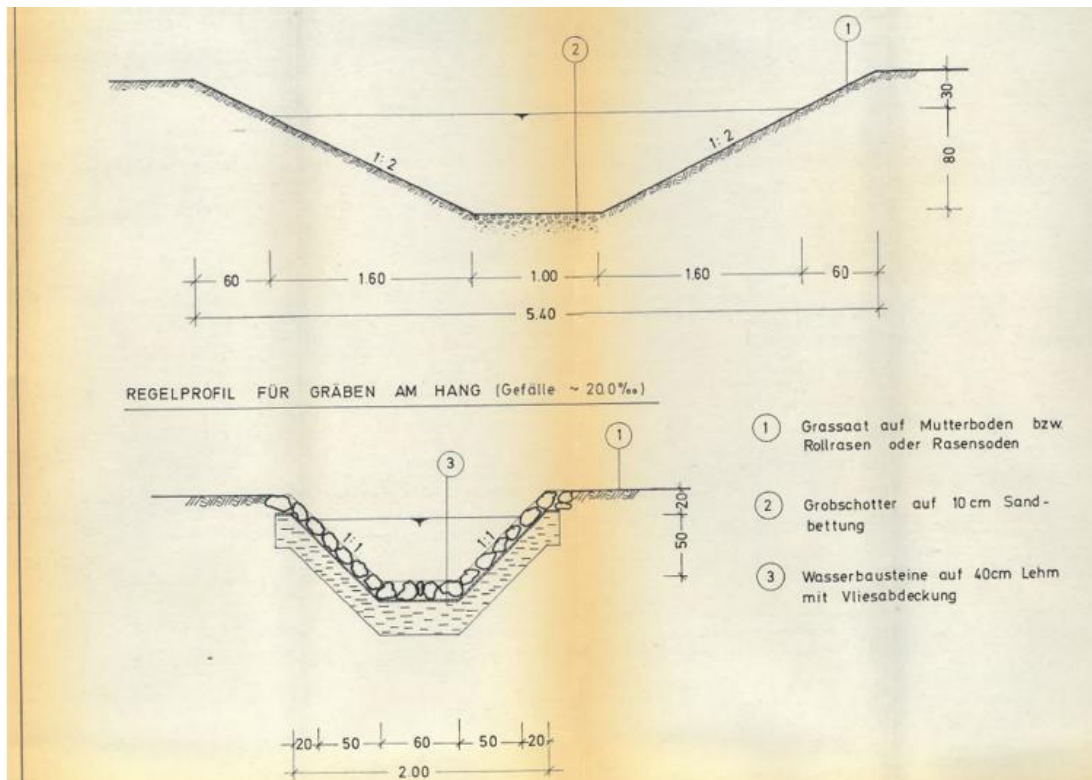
Regelprofil Sammelgraben aus Plan 7002 [U51]
